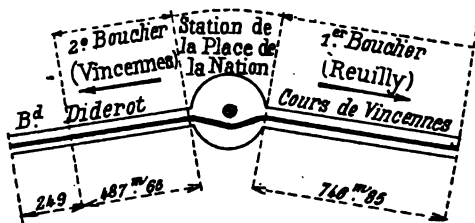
Plan du 1^{er} lot (division en chantiers).
